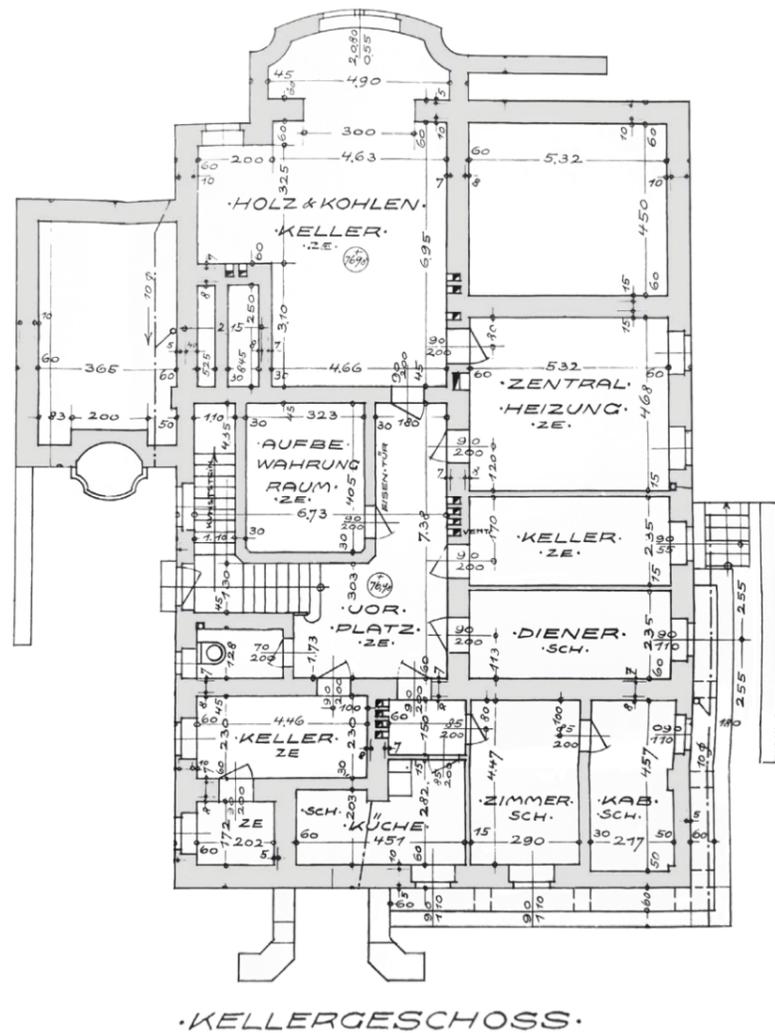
Grundriss Kellergeschoss 1922.
